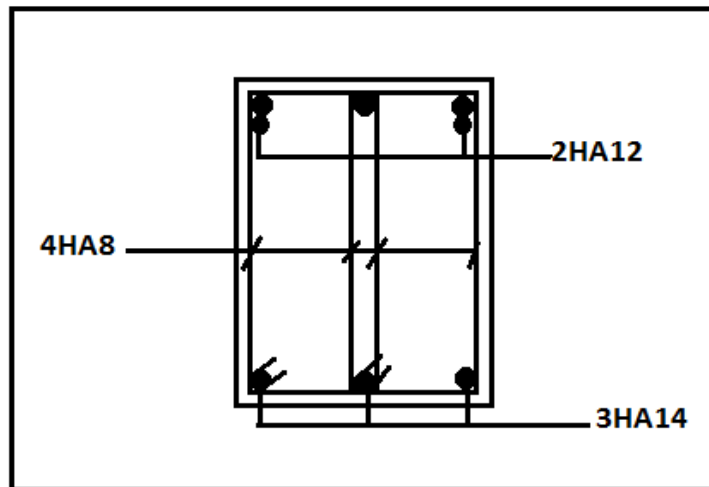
Ferrailage aux appuis d'une poutre secondaires .
